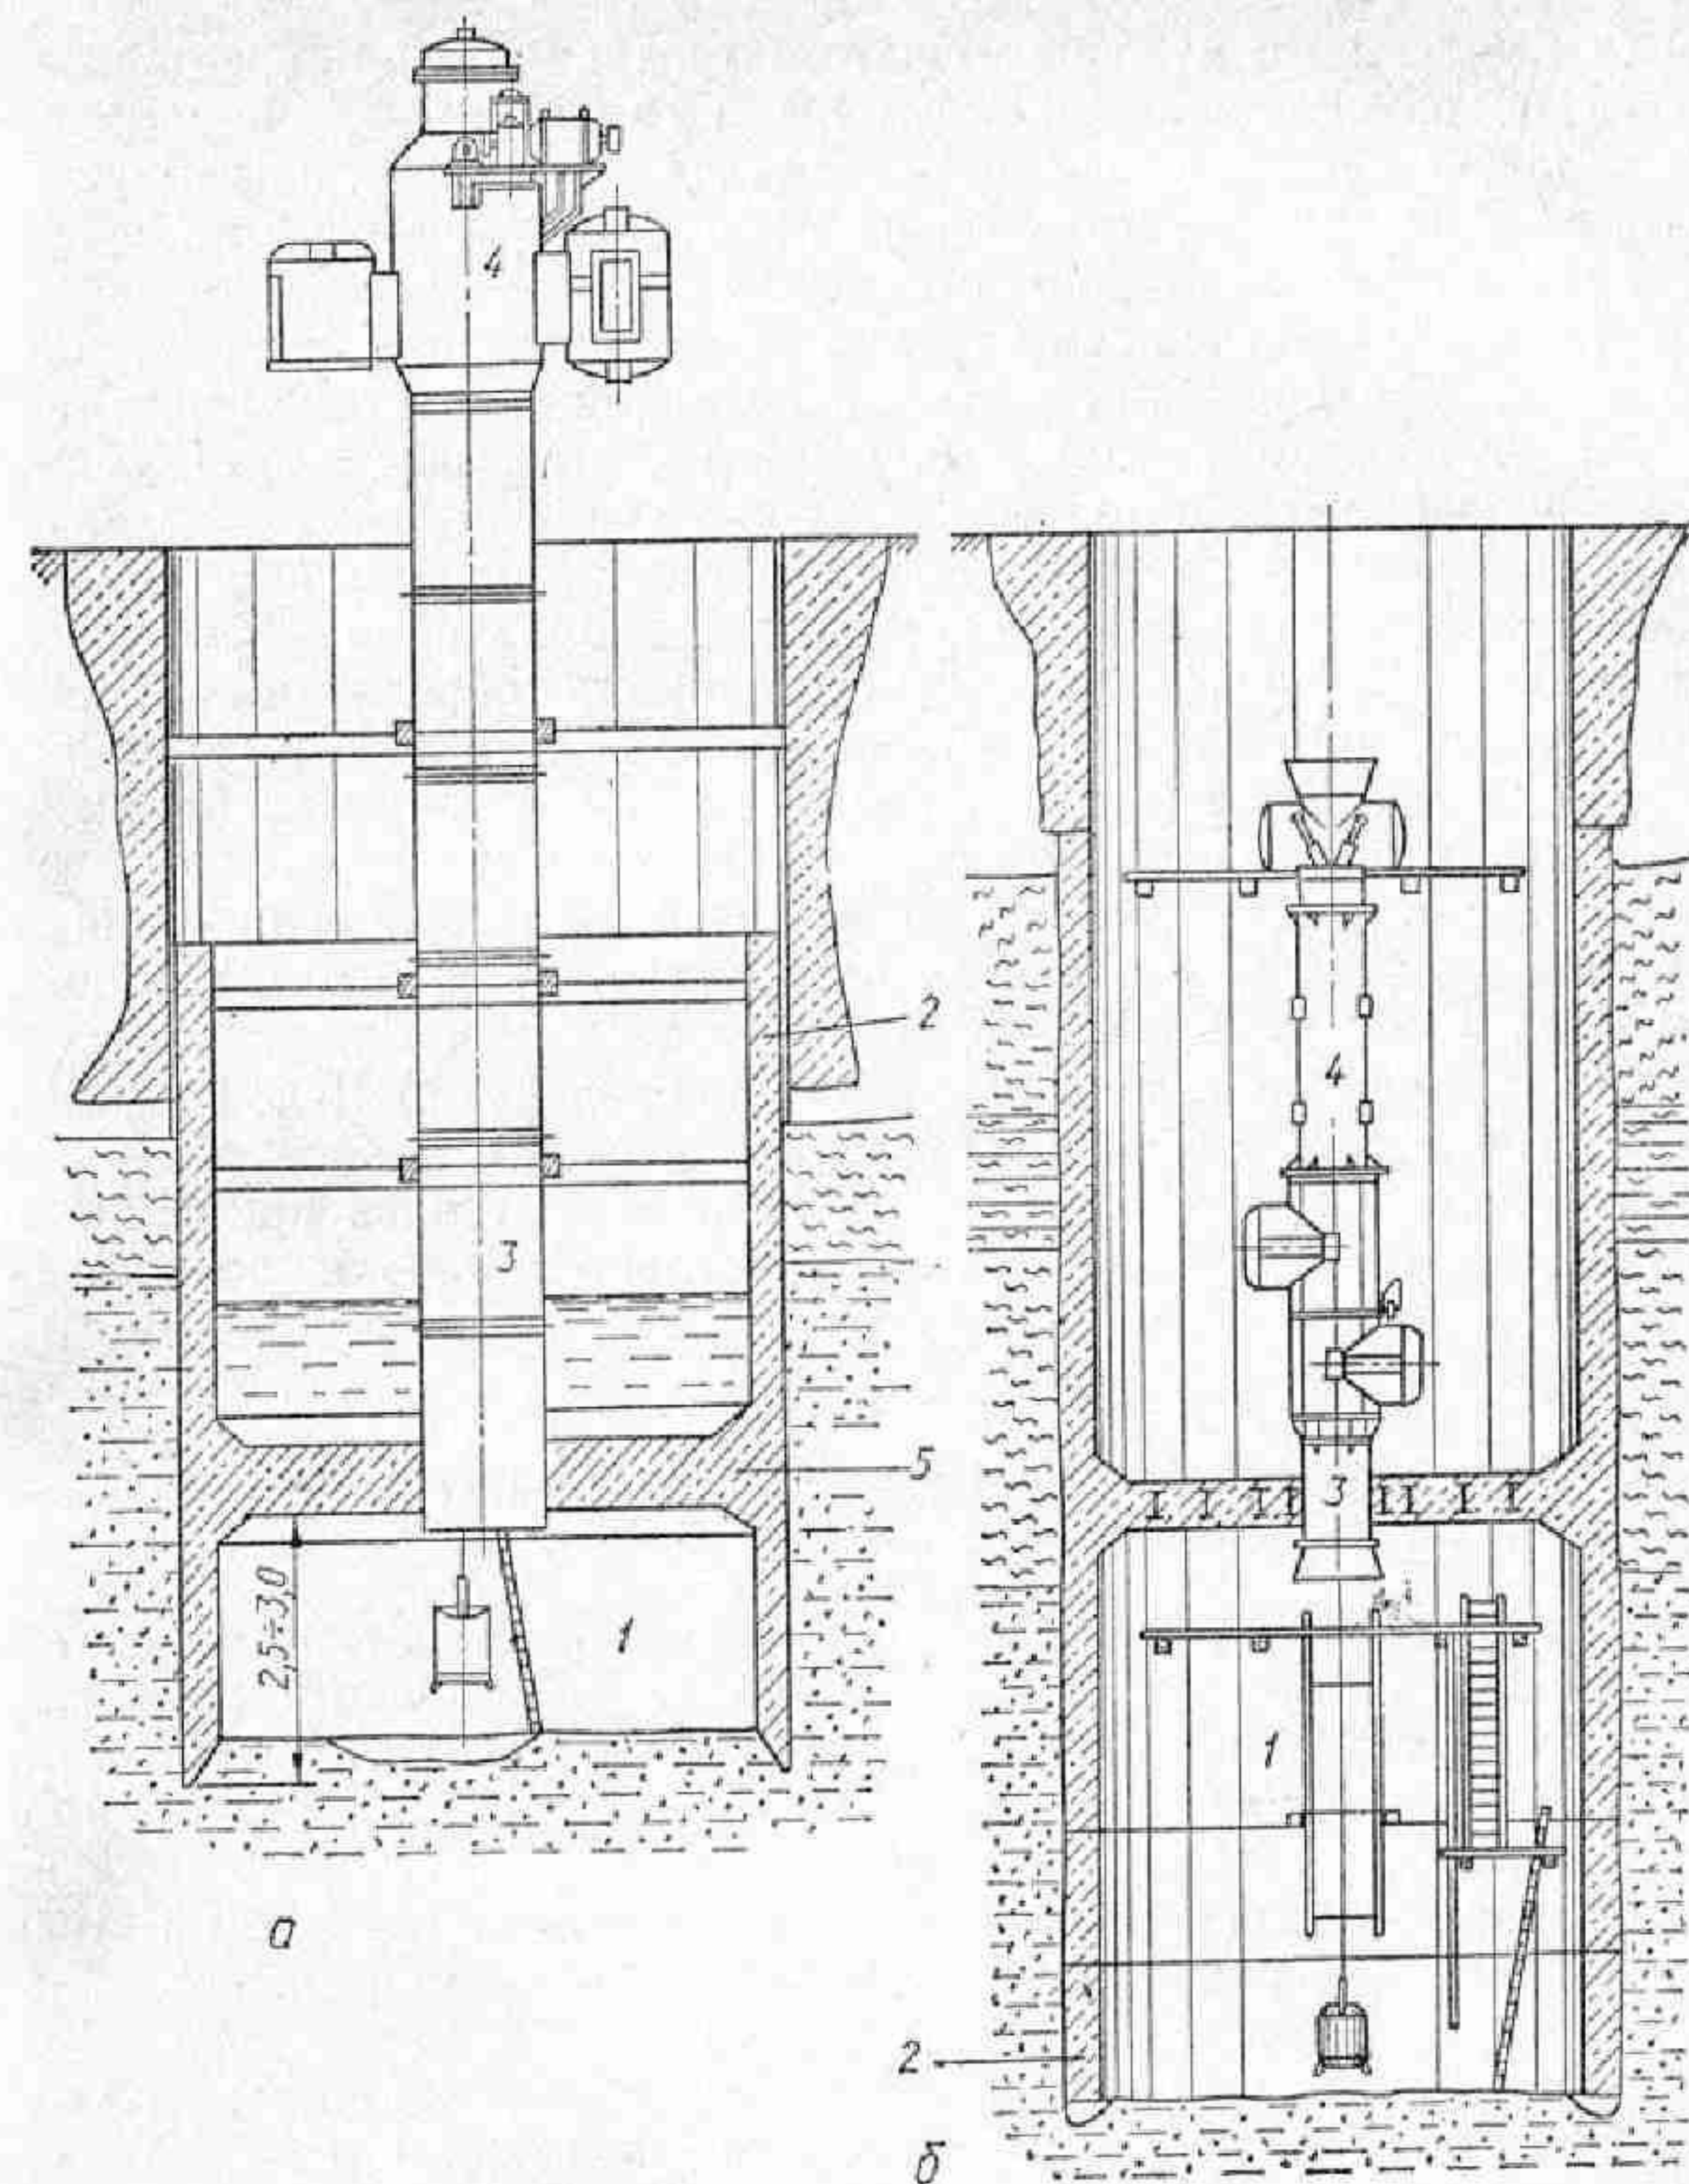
Схемы сооружения стволов под сжатым воздухом: а — с подвижной рабочей камерой; б — с неподвижной рабочей камерой; 1 — рабочая камера; 2 — стенки опускной крепи; 3 — шахтная труба; 4 — шлюзового аппарата; 5 — потолок рабочей камеры
